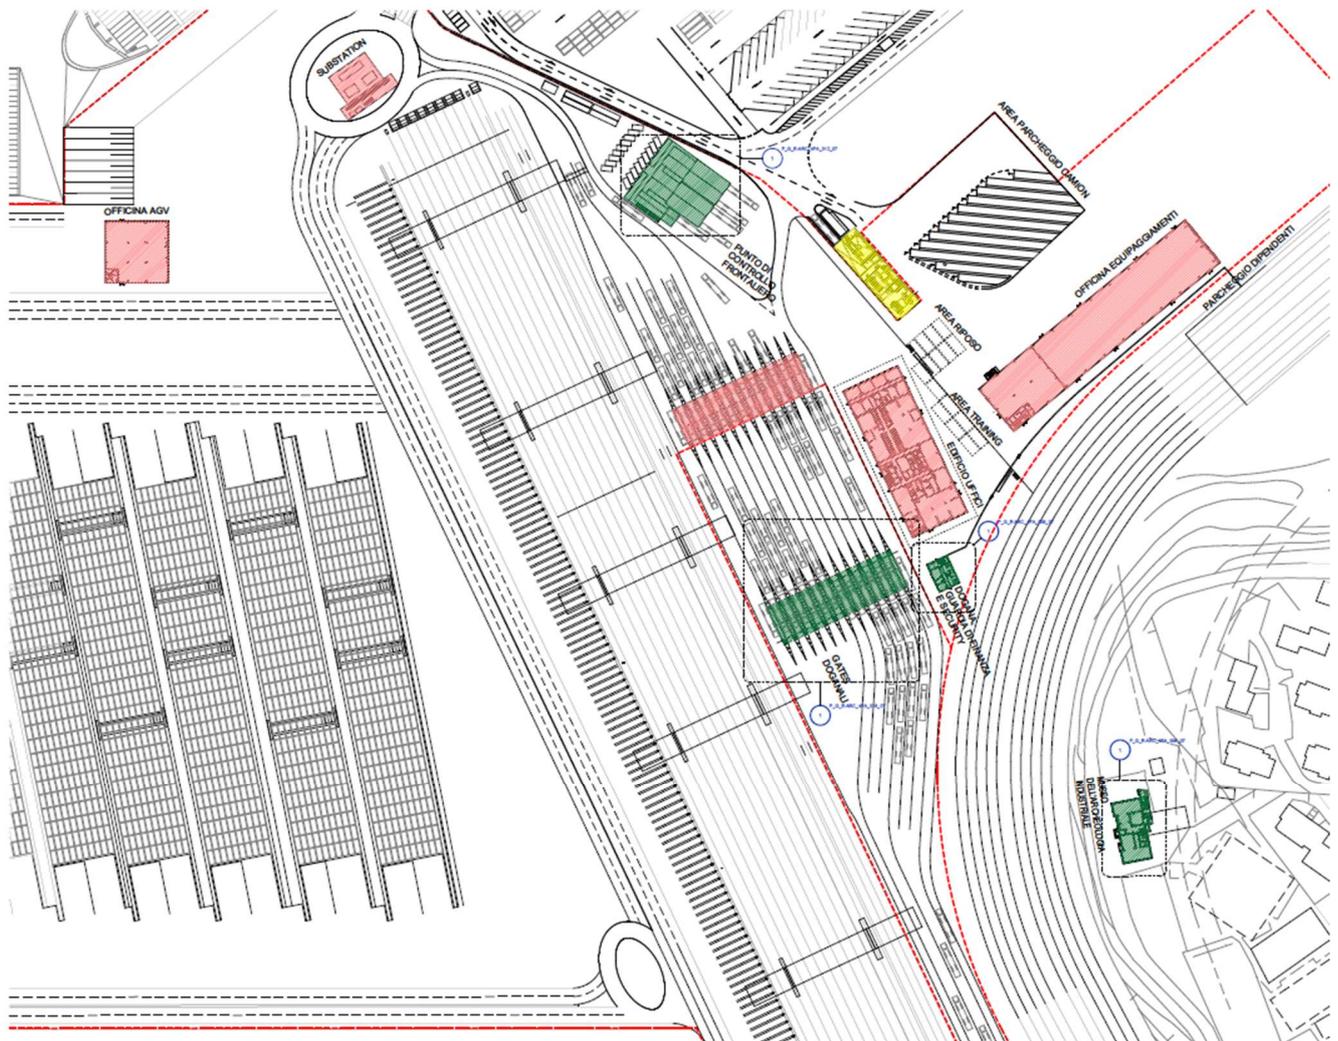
5EDF_P_G_E-ARC_4FA_002_07_00 – Planimetria generale di progetto
